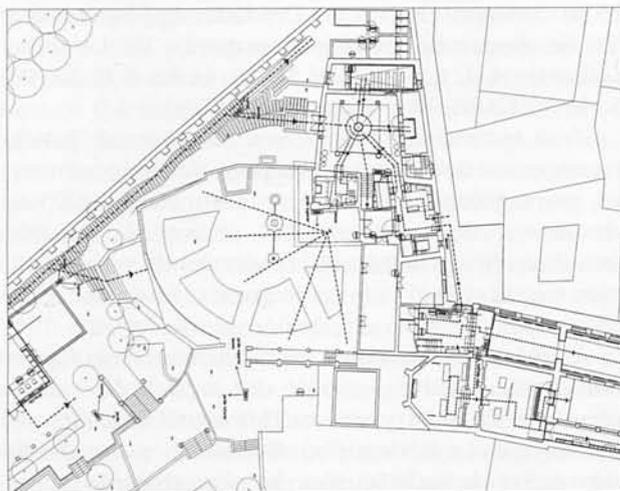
Nuevo Recorrido Planta baja. Proyecto: F. Pardo y B. García.
